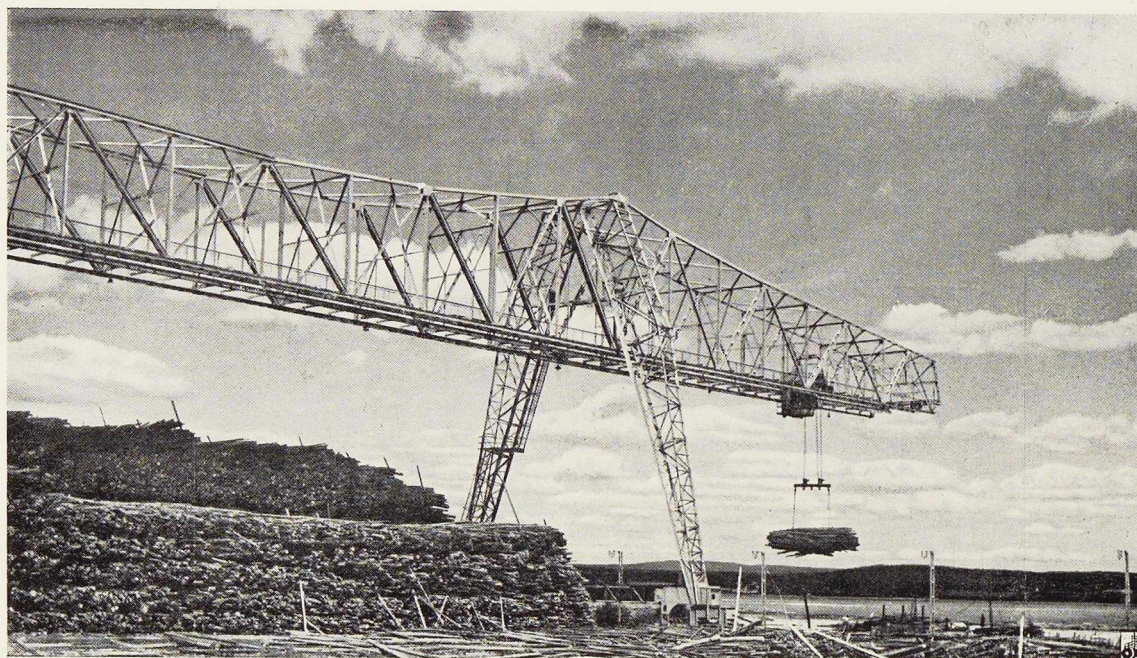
Elévation du pont-portique de 300 mètres de longueur construit à Sundsvall (Suède).
